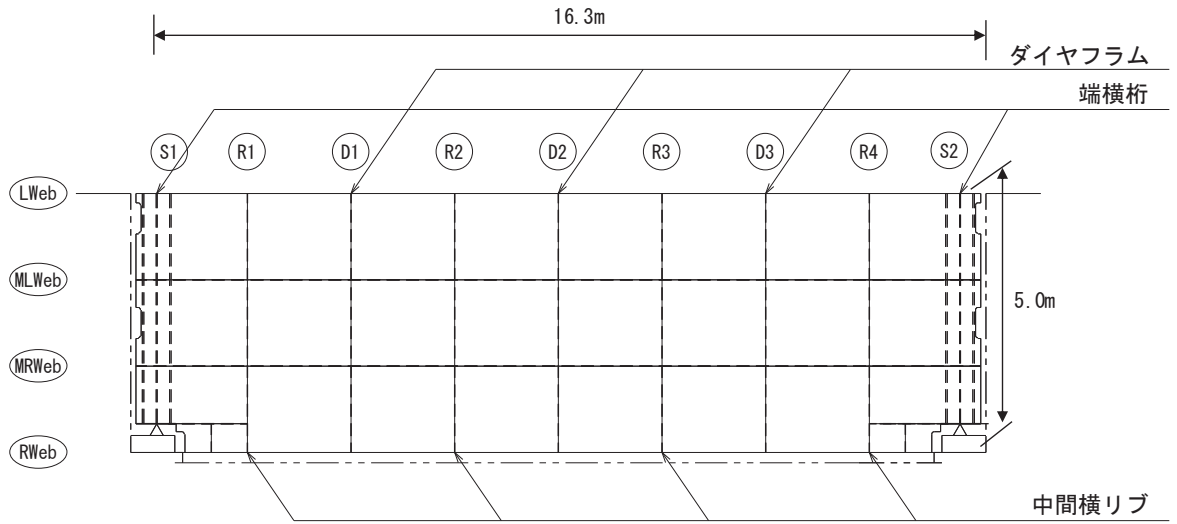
(2) 鋼製遮水壁（鋼桁 6） 平面図
